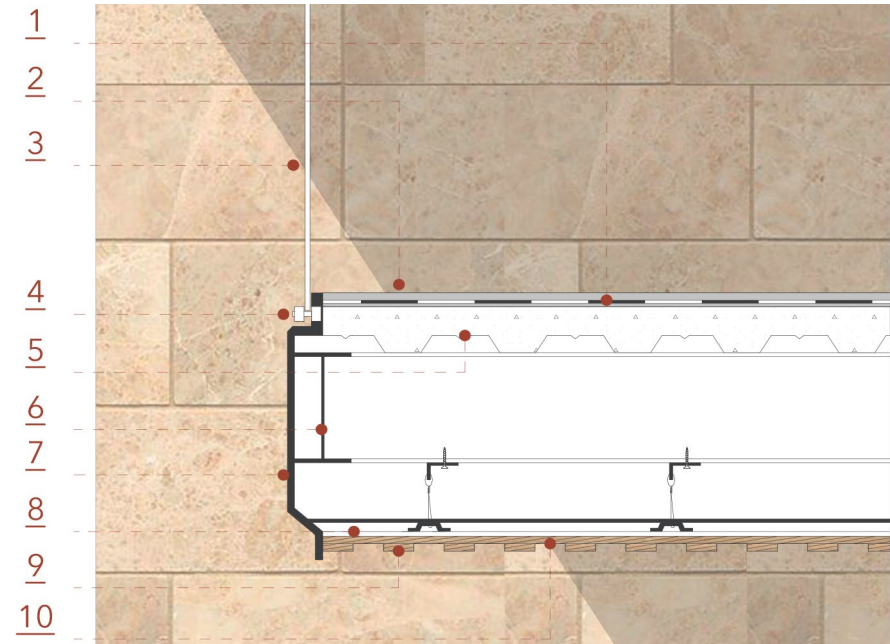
Detalle constructivo de remate inferior en fachada de vidrio. Gráficos de la autora.
